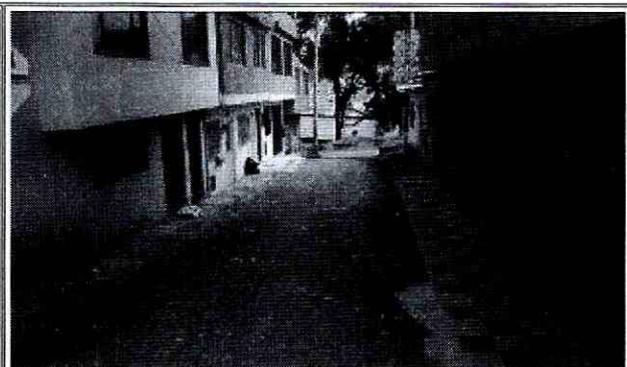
Vista de la Carrera 2 C Este Barrio Progreso II Sector la Reforma – Enero de 2017
